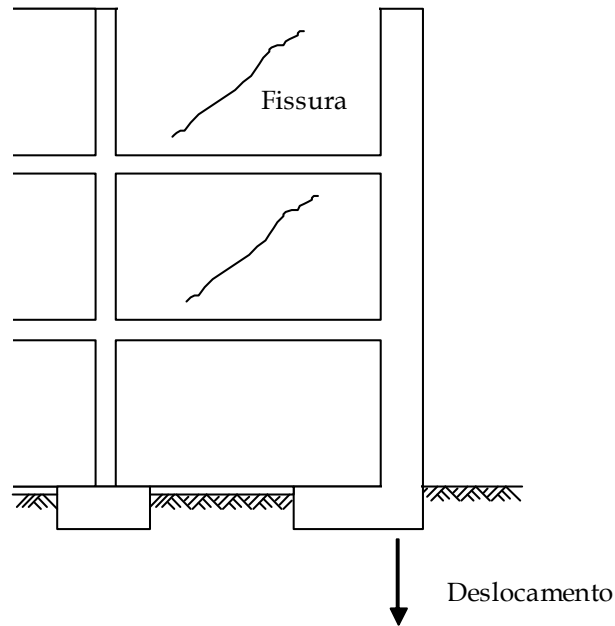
Esquemática das fissuras típicas causadas por recalques de fundações, pilar de canto (URIEL ORTIZ, 1983 *apud* MILITITSKY et al., 2005).
